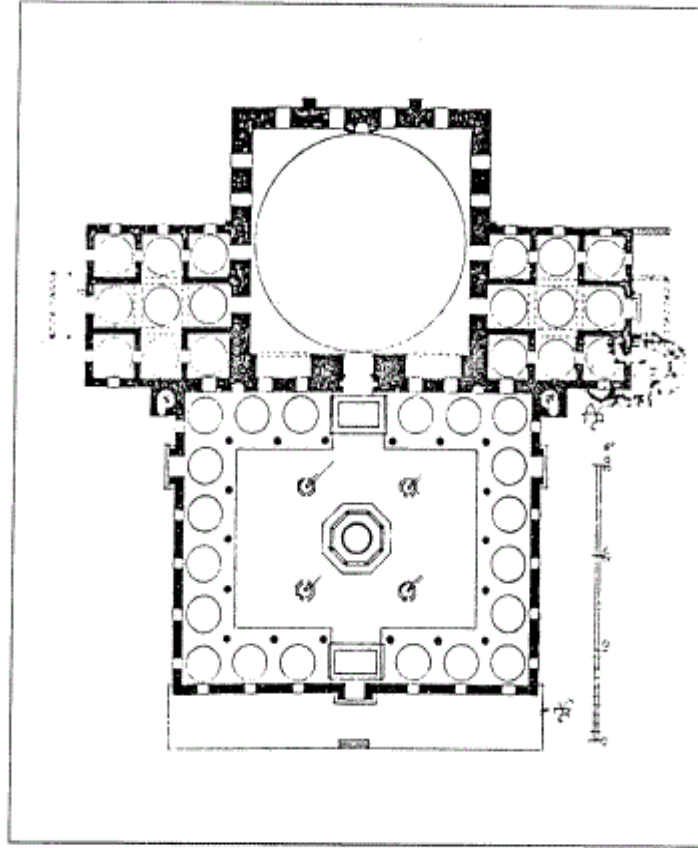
مسقط أفقي لمسجد الحنكار أو الحاكم في الباسان بالبنيا (عن : كيل) .
